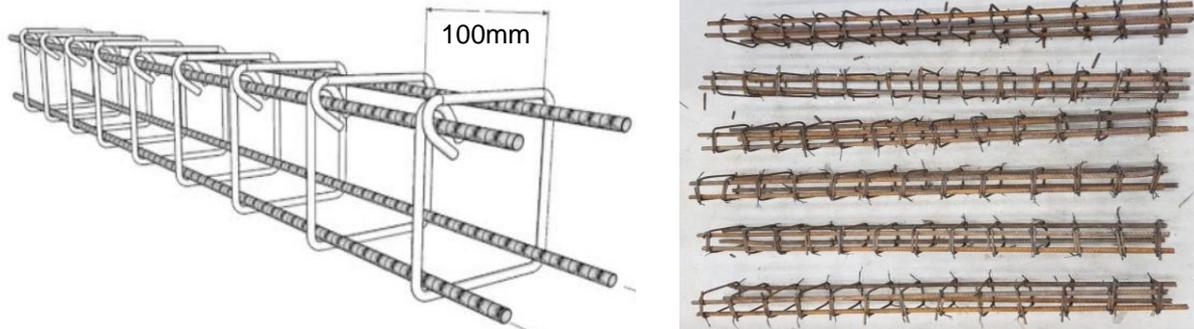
Detalhamento da armadura da viga padrão empregada neste estudo.
